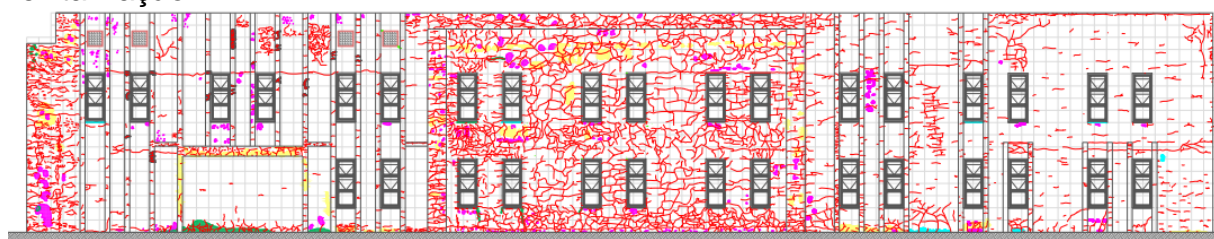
Manifestações patológicas da fachada leste, onde: a) Fissuras mapeadas e horizontais; b) Fissuras verticais; c) Sujidades e d) descascamento
